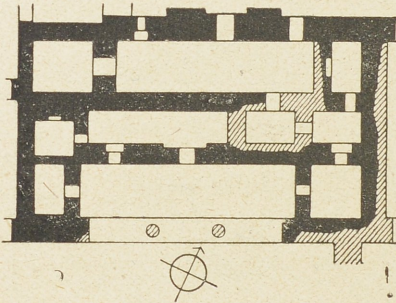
Hilani in Ninive-Kujundschiik, ergänzter Grundriss. Maßstab 1:1000.
